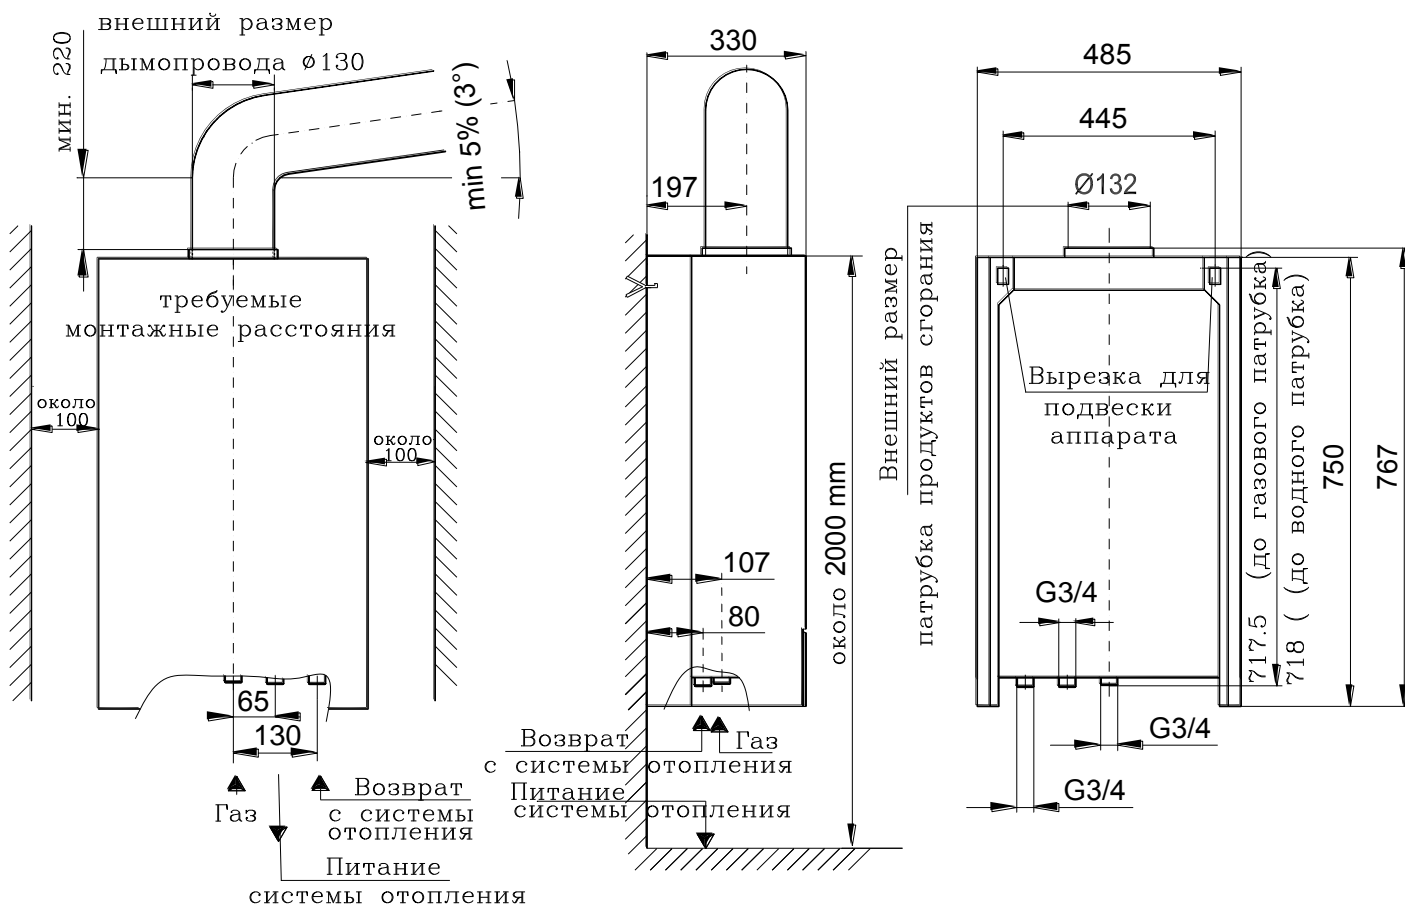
Установочные размеры аппарата типа В uniCO-29-16
